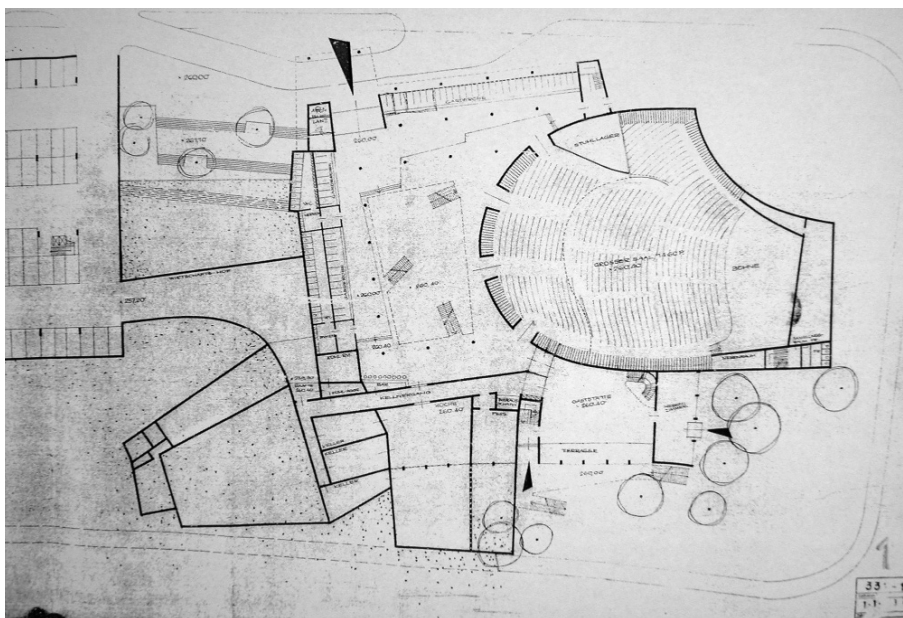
Entwurf, Erdgeschossgrundriss 1953.
